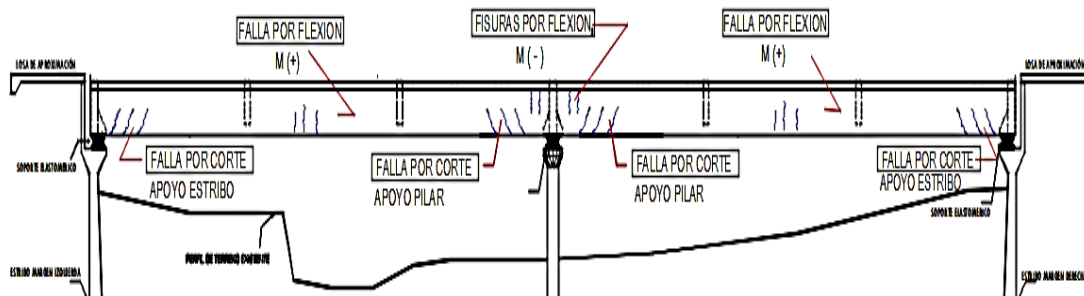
Mapeo de fisuras encontradas en la superestructura puente “La Capilla” información obtenida en campo.
